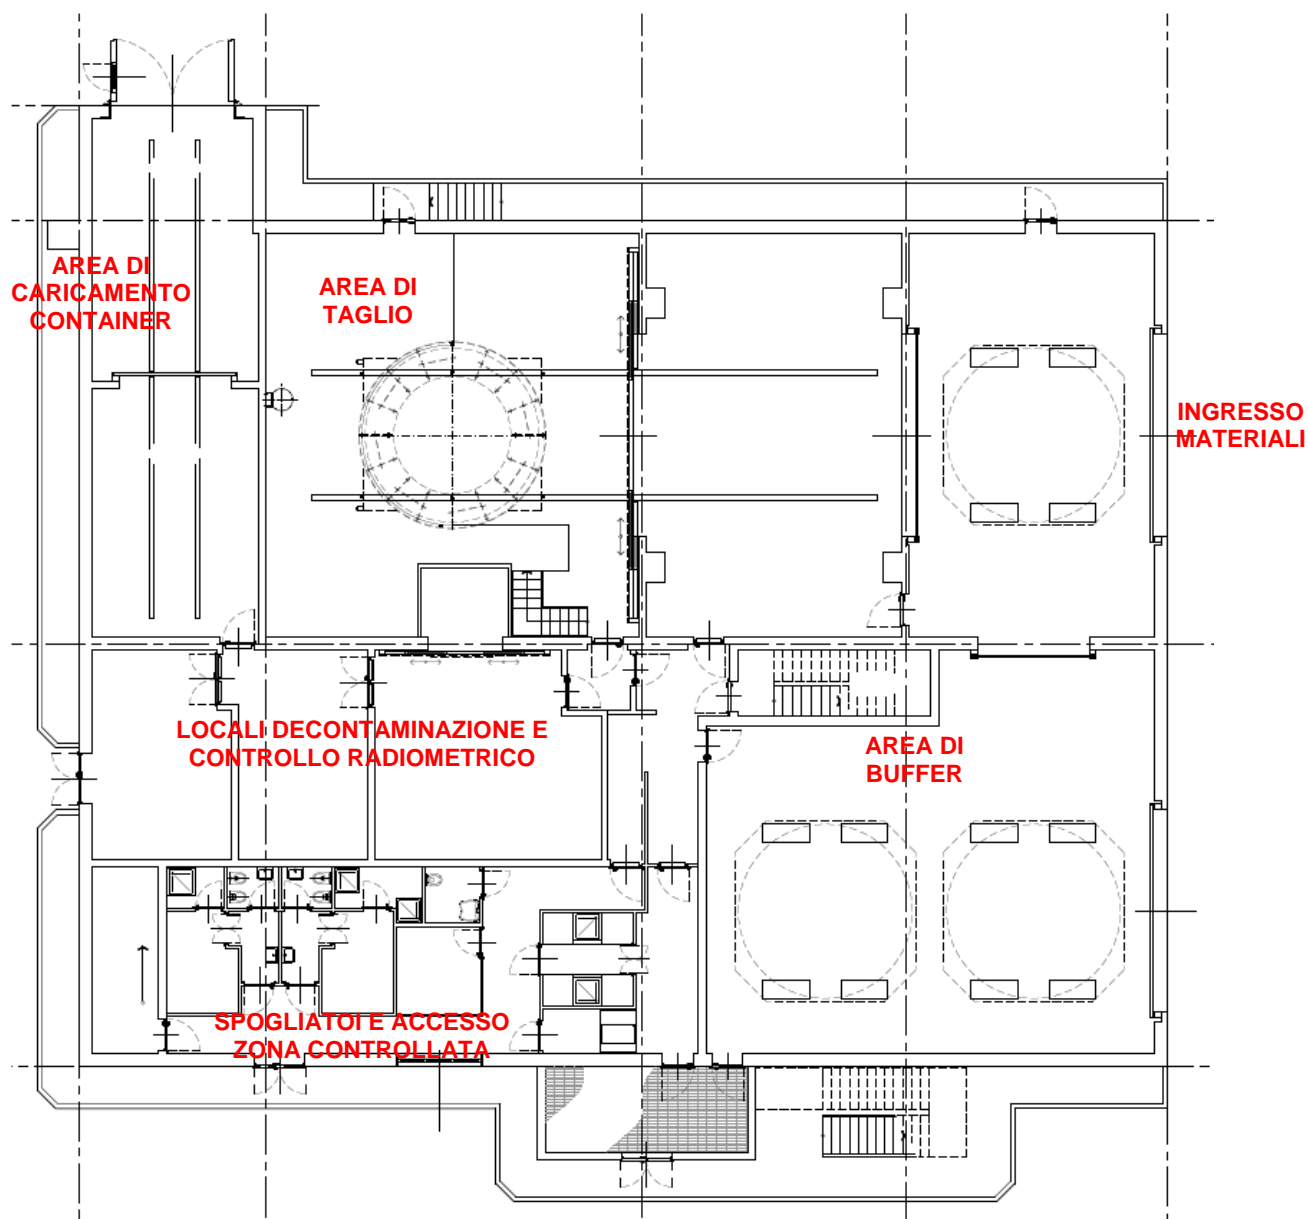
Stazione Trattamento Materiali – Pianta Piano Terra
